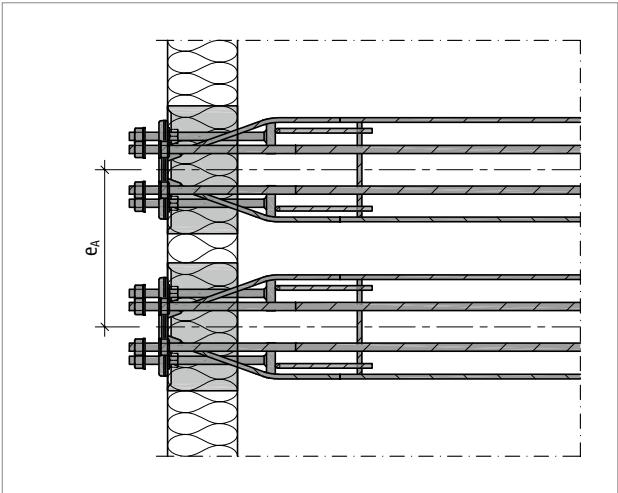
Schöck Isokorb® XT type SK : espacement axial
